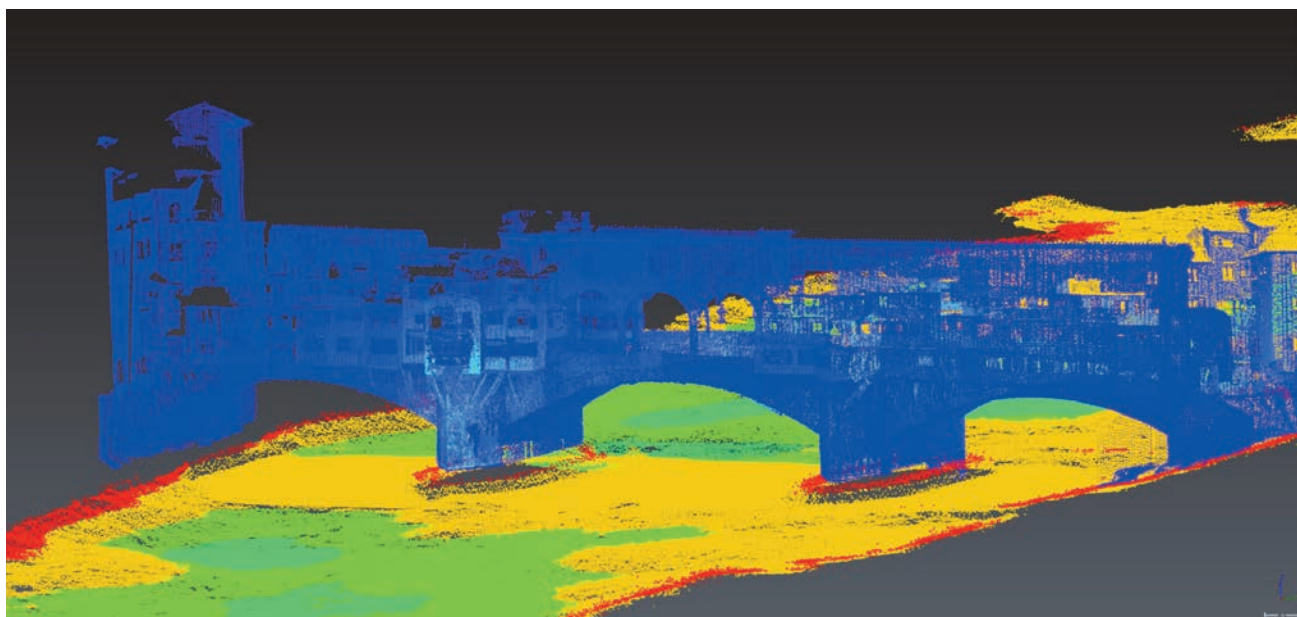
Vista prospettica del Ponte Vecchio e delle platee di fondazione.
